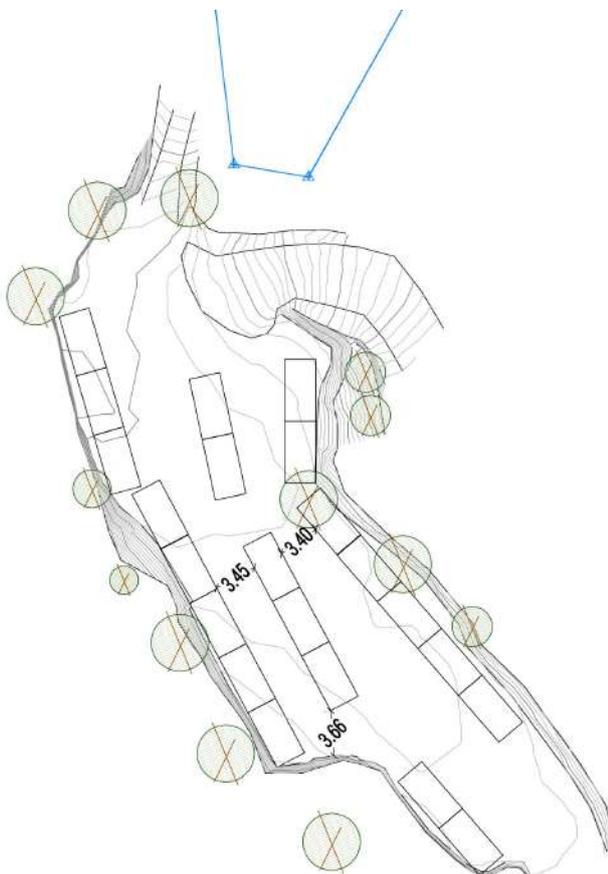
Plano de la alternativa 3 de aparcamiento reducido.
